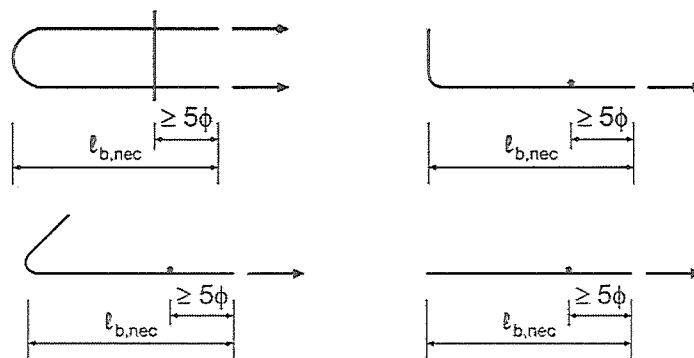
Ancoragem com barras transversais soldadas
